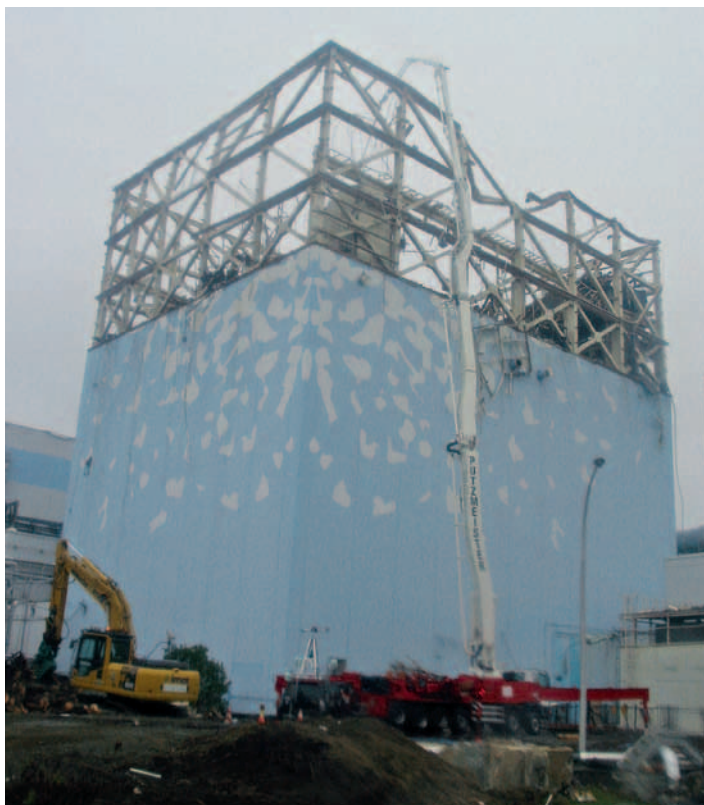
Einspeisung von Wasser in das Brennelementlagerbecken des Blocks 1 mit einer Autobetonpumpe (Quelle: TEPCO).
